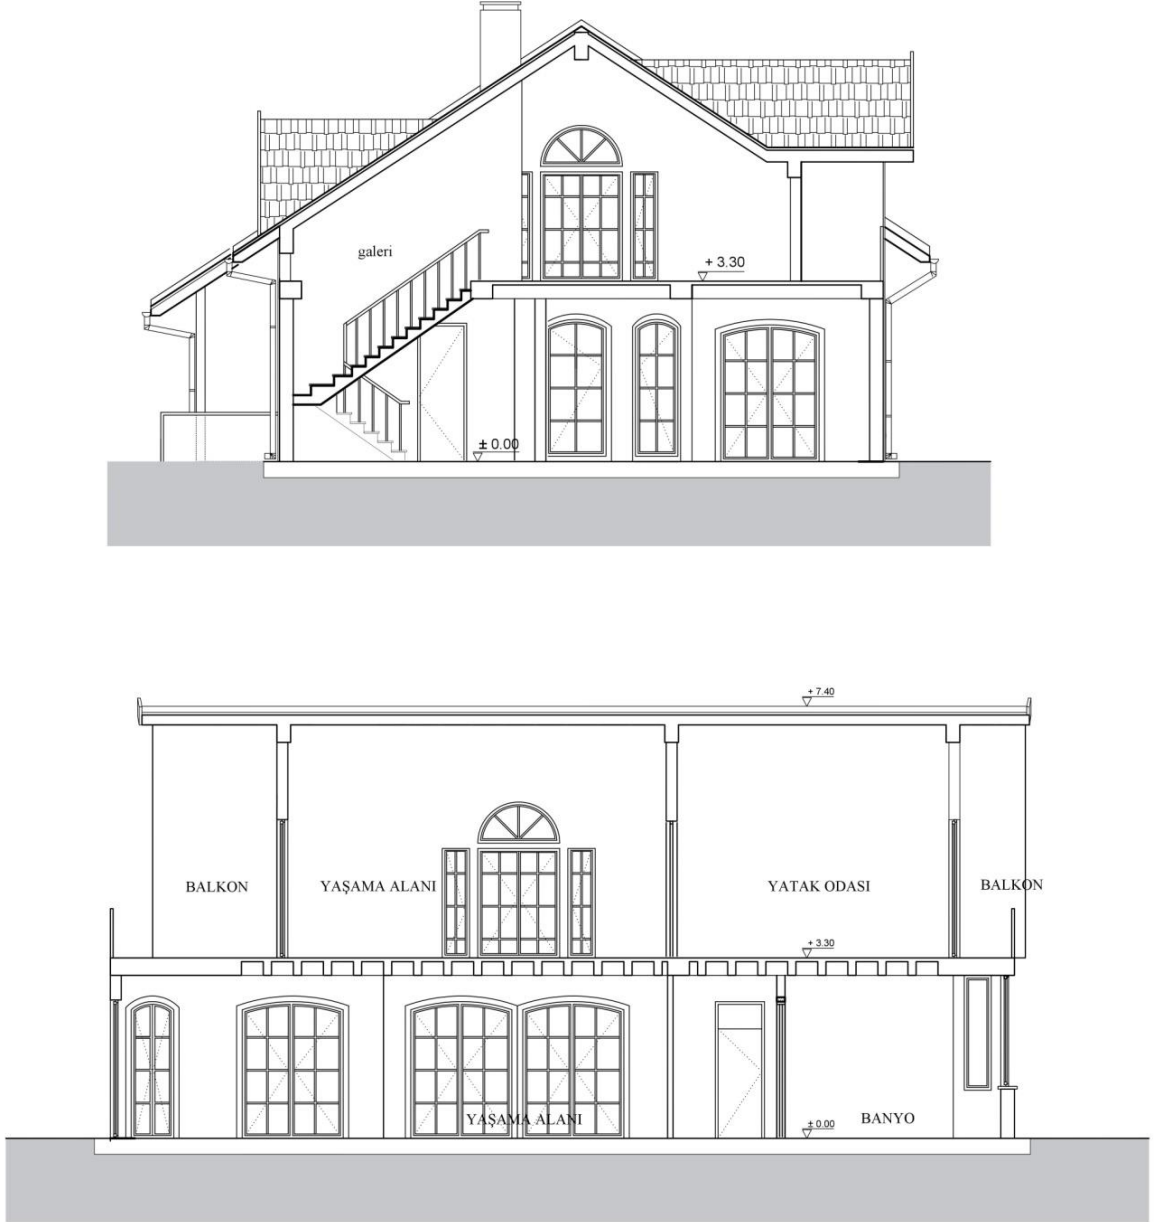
Eğimli betonarme çatı (<http://www.kmyapi.com/hizmetlerimiz/20/beton-uzeri-ahsap-cati>)
